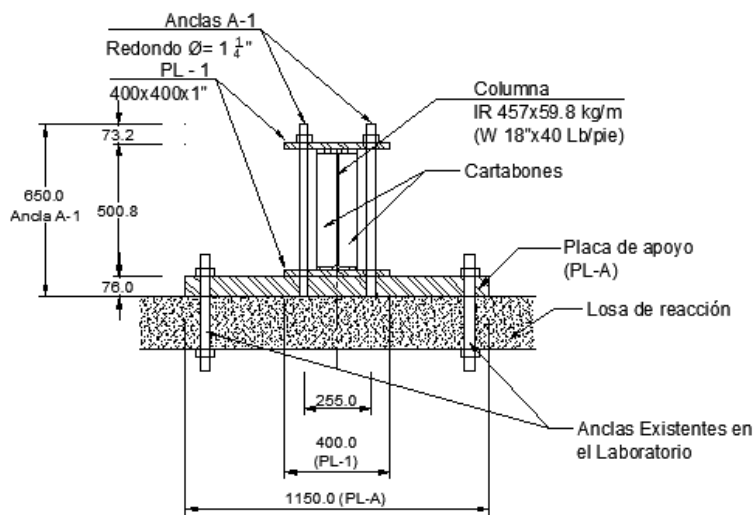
Detalle de los apoyos, vista frontal (Corte B-B). Cotas en milímetros
